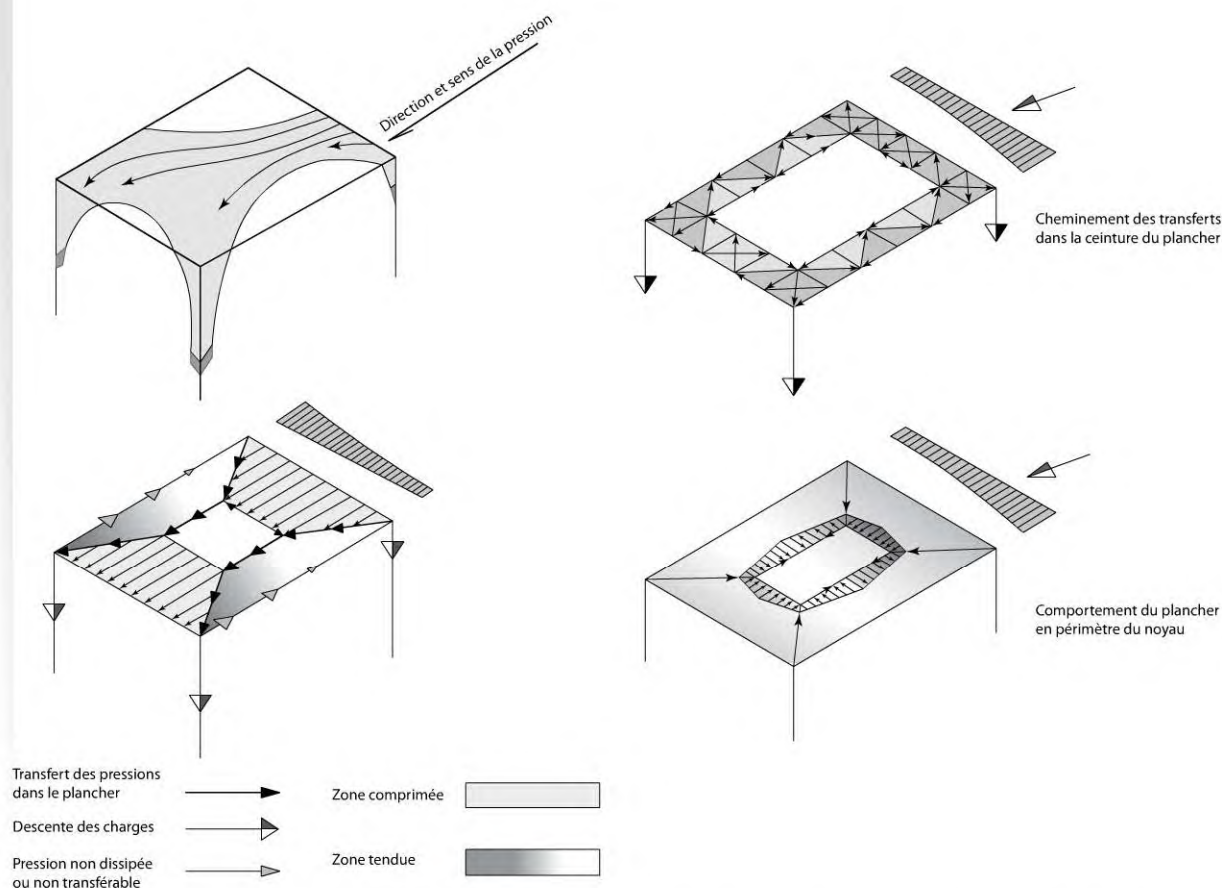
Répartition des pressions sur le plan d'un plancher plein.
